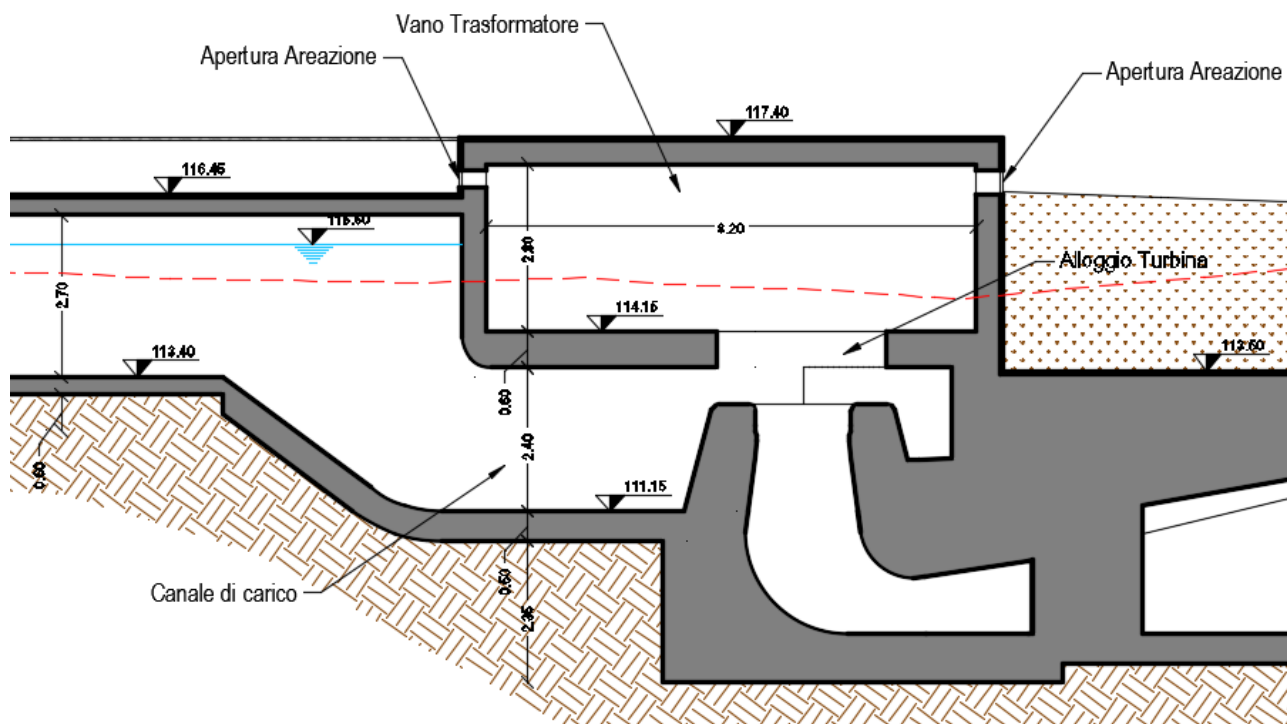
VISTA IN SEZIONE DELL'IMPIANTO
